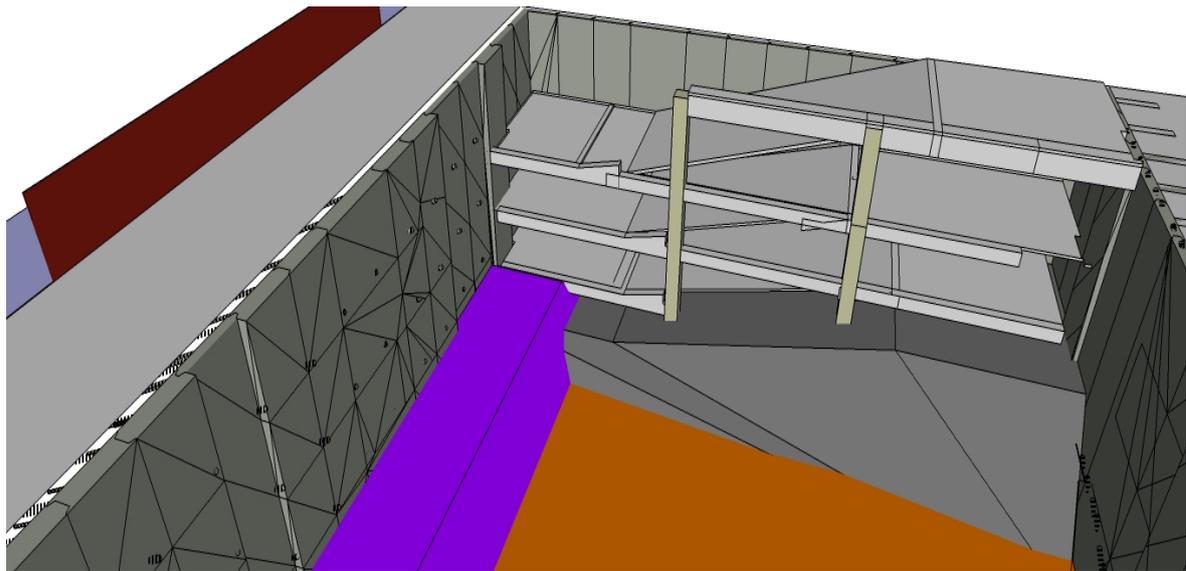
Baugrubenaushub nach dem Abtragen der Erdschicht [5]
